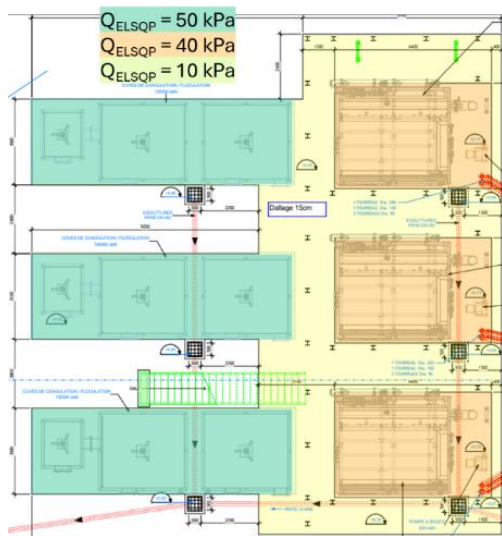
Système de fondations du bâtiment « Coagulation Flocculation »
